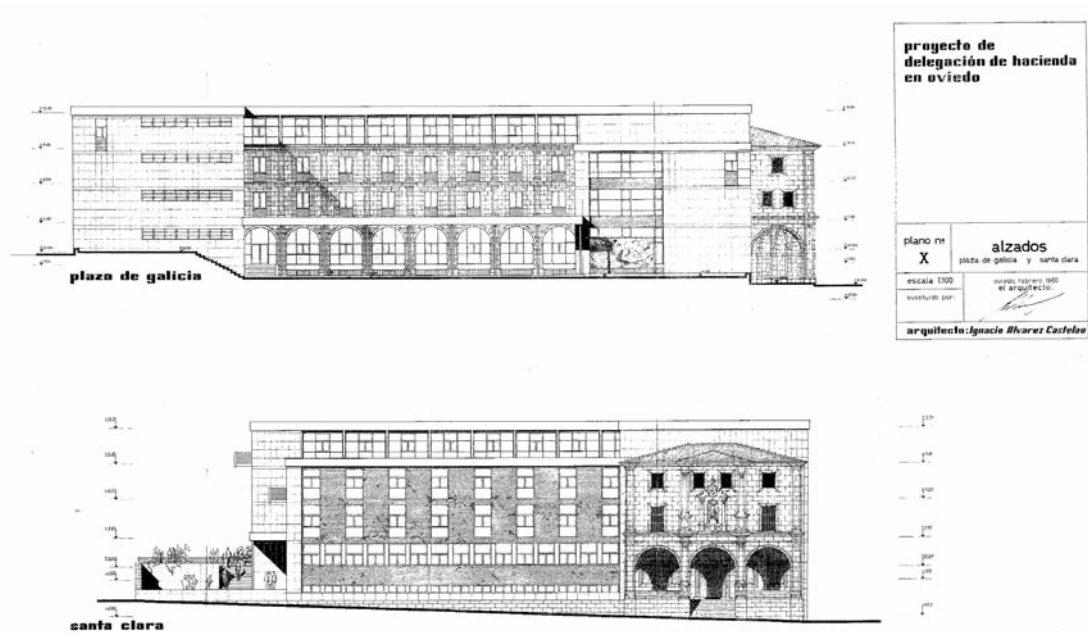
Proyecto de Delegación de Hacienda en Oviedo, 1960. Arquitecto, Ignacio Álvarez Castelao. Delineante, Antonio Trelles. Alzado Este, a la plaza de Galicia, y alzado Norte, a la plazuela de Santa Clara. (Archivo particular de la familia Álvarez Castelao).
